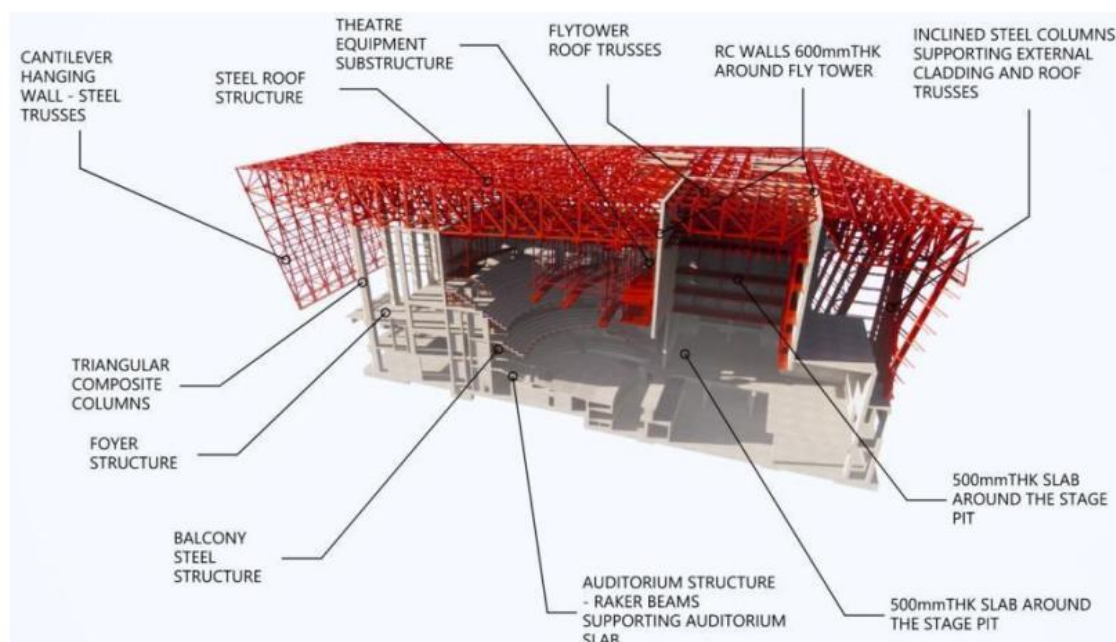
Corte transversal del teatro, evidenciando los principales elementos metálicos de cubierta y fachada
